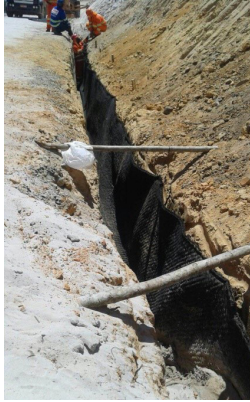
Sistema drenante instalado. (Fonte: Elaborada pelo autor).
